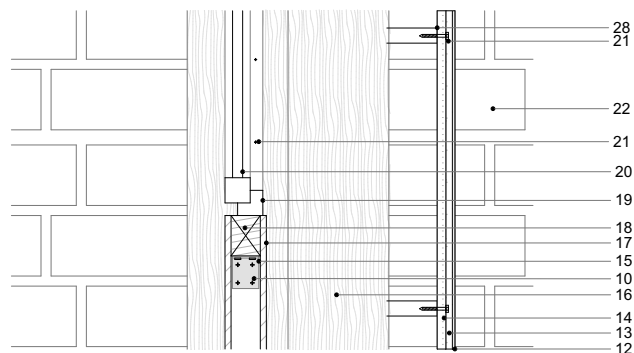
D5 Detalle constructivo antepecho, muro abobe con recubrimiento
